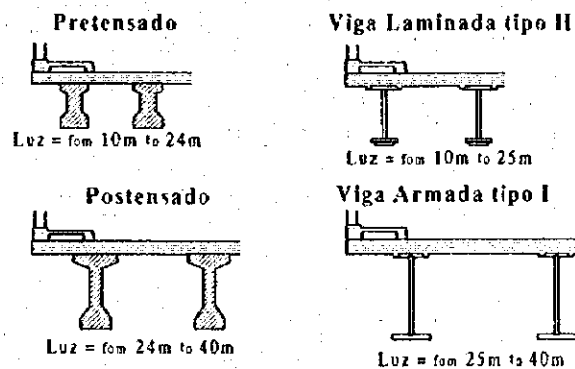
Tipo de Puente Estándar (Superestructura)
